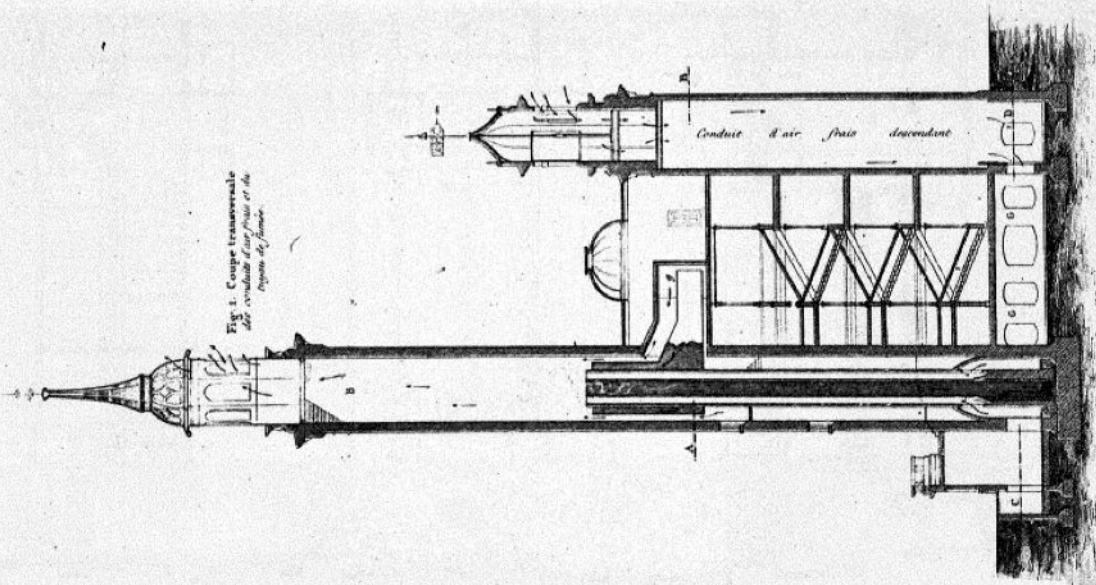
Coupe transversale d'un conduit d'air frais et du système de fumée.
